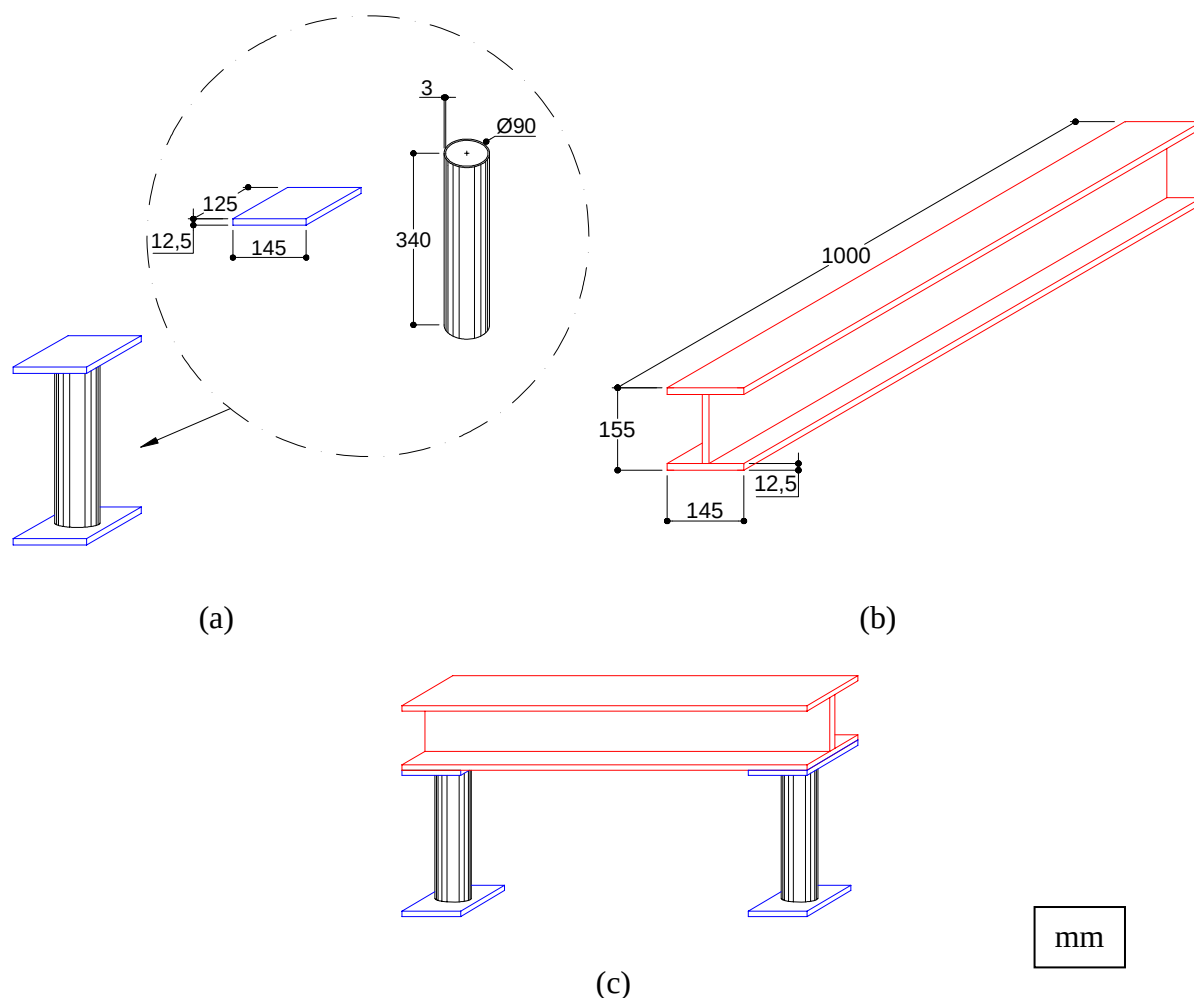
Detalhe da montagem do pórtico de reação. (a) Montagem do pilar, (b) Viga metálica, (c) Montagem do pórtico.
